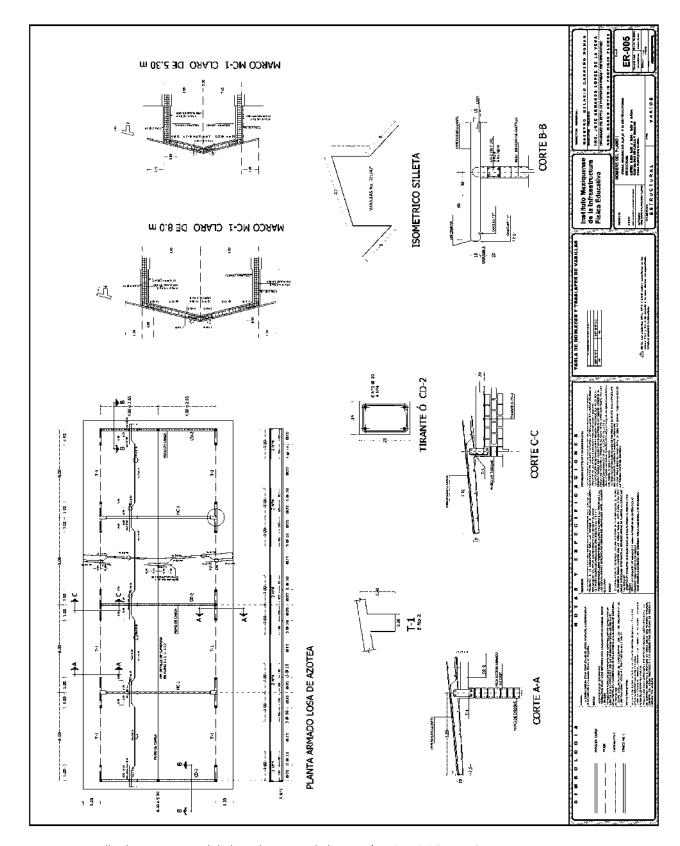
Detalle Plano estructural de losa de azotea de la escuela primaria Vicente Guerrero.
